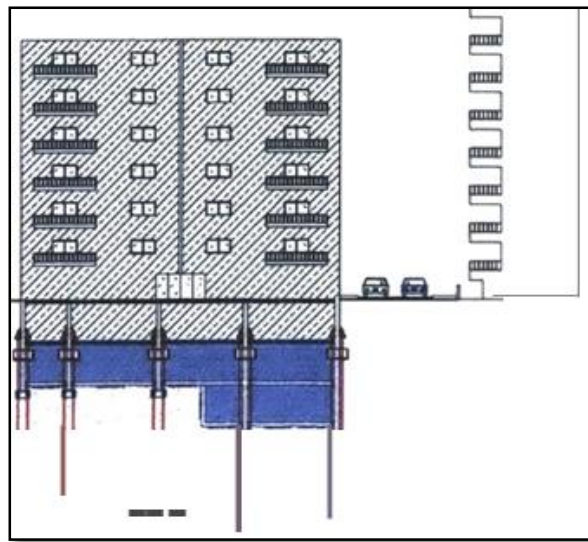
Sección transversal del edificio, Beirut (Líbano).
